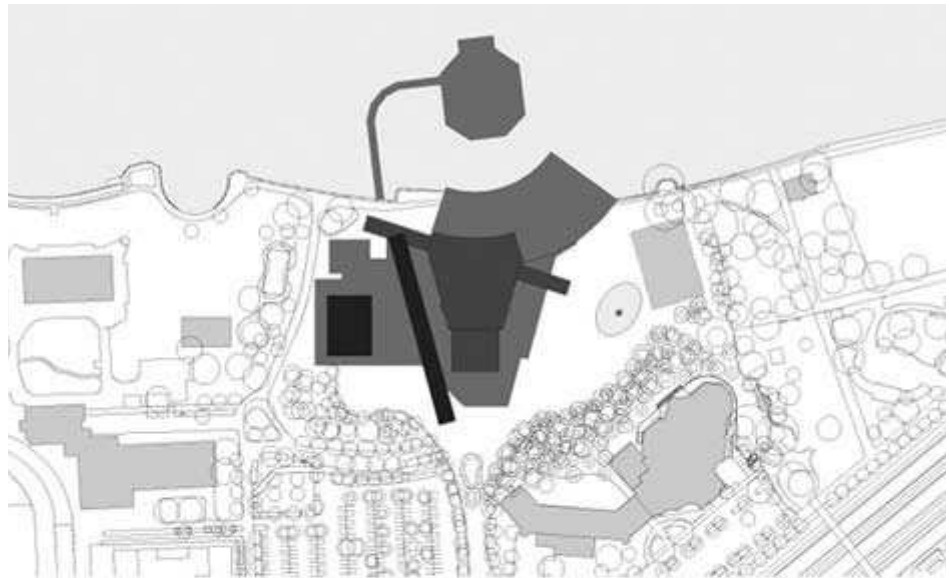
planimetria generale della Festspielhaus e Kongresshaus di Bregenz
